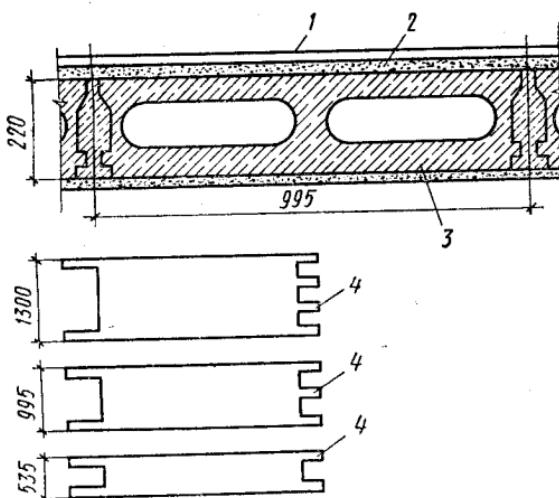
Сборные железобетонные пустотные настилы для замены перекрытий:
